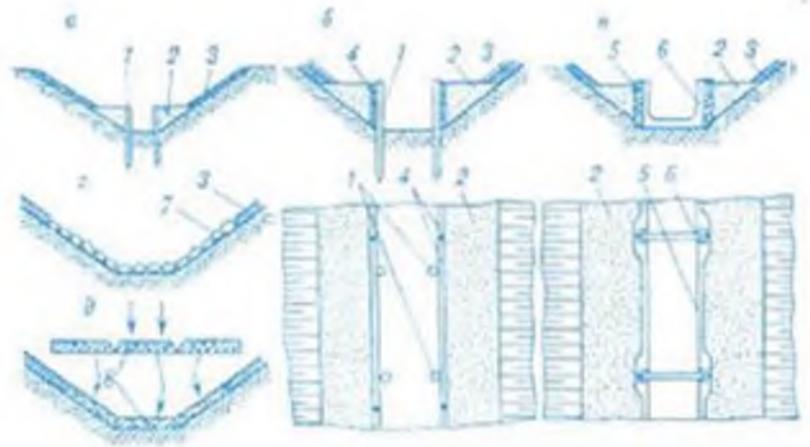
Крепление откосов и дна каналов. Крепление нижней части русла кольями и засыпкой грунтом, закрепление откосов одерновкой или посевом трава, б — крепление плетевыми стенками, в, д — железобетонными плитами, з — каменной отсыпкой; 1 — кольца (дерсаянные свайки), 2 — засыпка грунтом, 3 — одерновка или посев трава, 4 — доски, 5 — железобетонные плиты, 6 — П-образные железобетонные распорки, 7 — каменная отсыпка по песчаной подготовке, 8 — железобетонные плиты, укладываемые на дно и откосы канала при размывающих скоростях течения.
